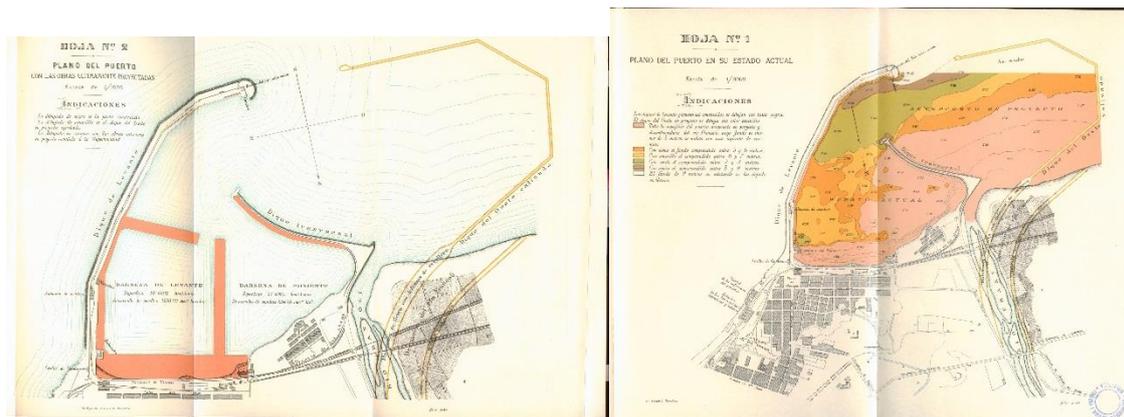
y 78. Plano de las últimas obras del puerto proyectadas por Saturnino Bellido.
